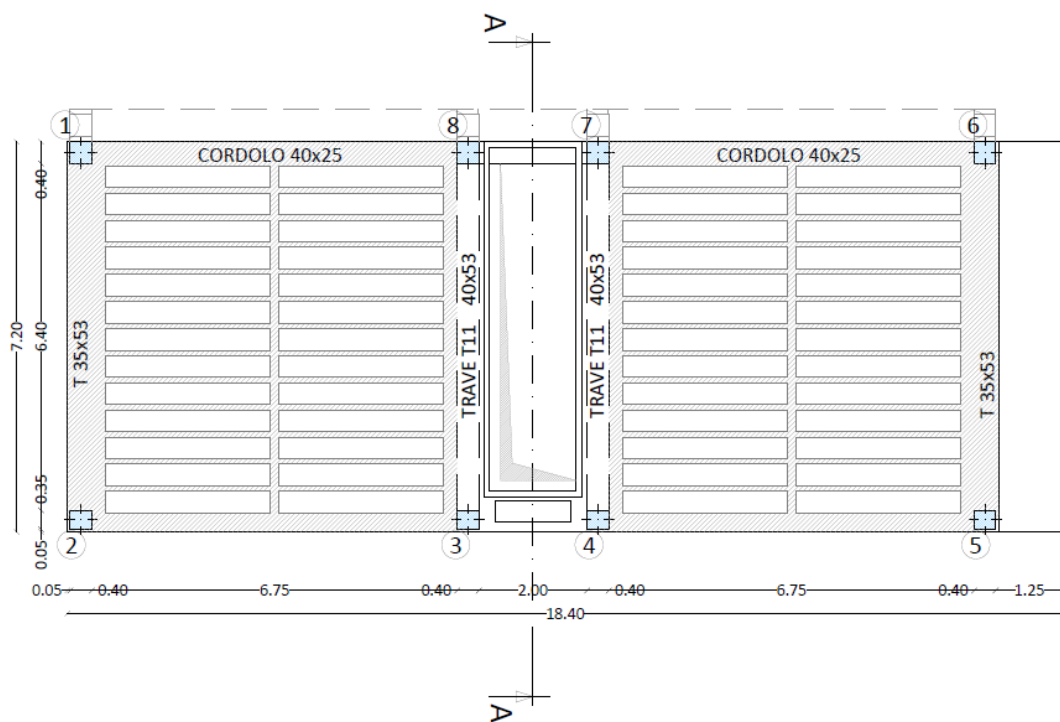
Blocco Q-Planimetria Struttura Piano Copertura Esistente.
